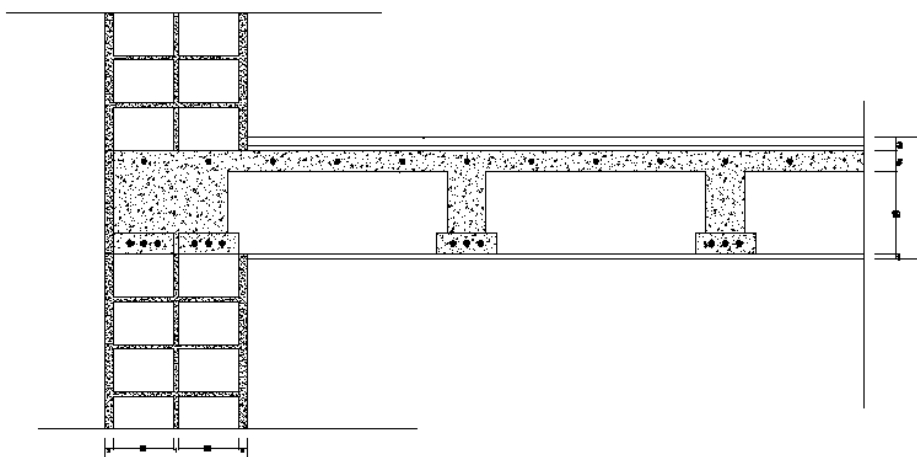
Sezione Solaio – cordolo con travetti prefabbricati
